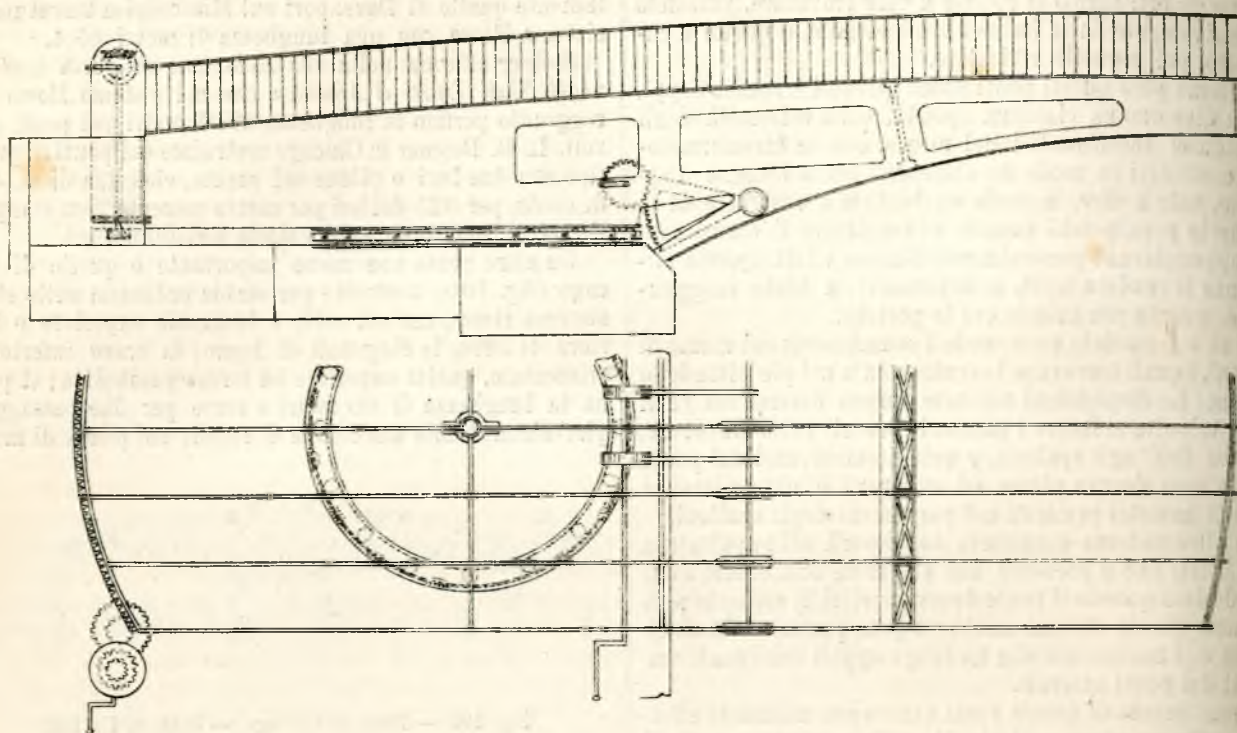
Prospetto e pianta di ponte girevole sui bacini di Londra. — Scala di 1 a 100.
